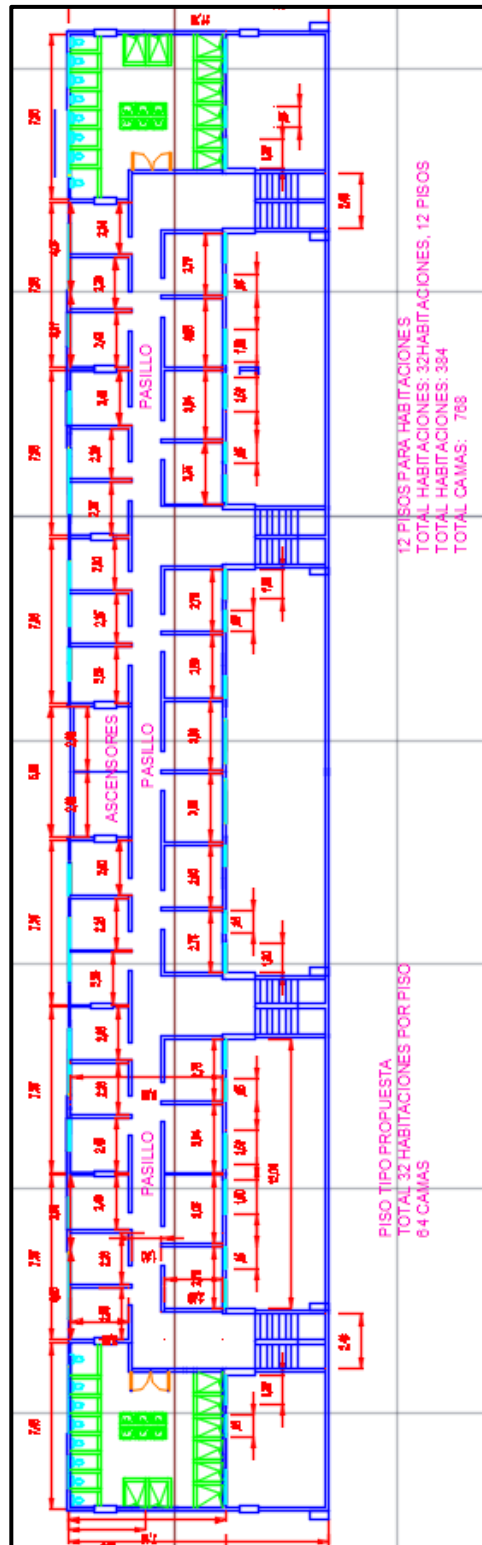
Planta Propuesta habitaciones por piso Bloque C-2 Ramírez 2024.
